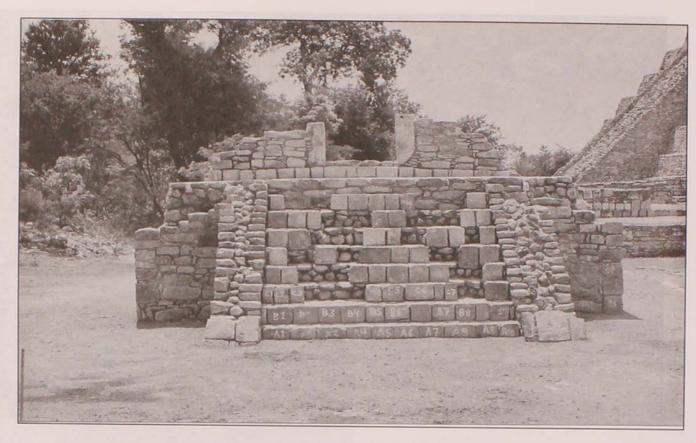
Fachada de la estructura Q.149, después de la consolidación
